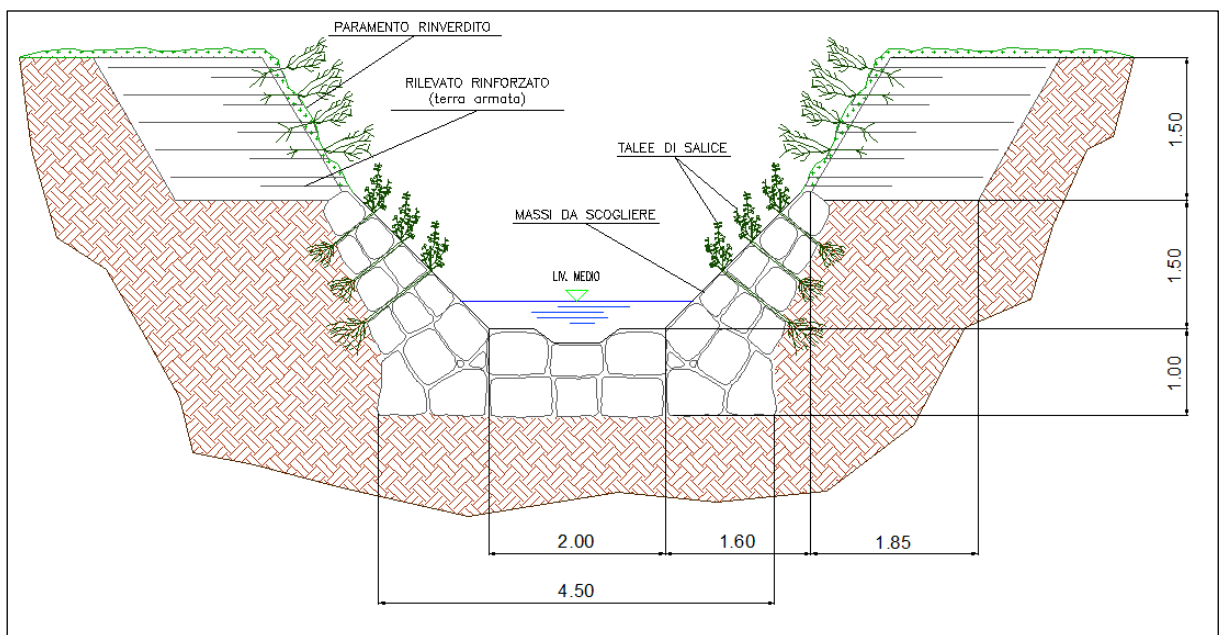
Sezione tipo del canale previsto per la seconda soluzione progettuale
